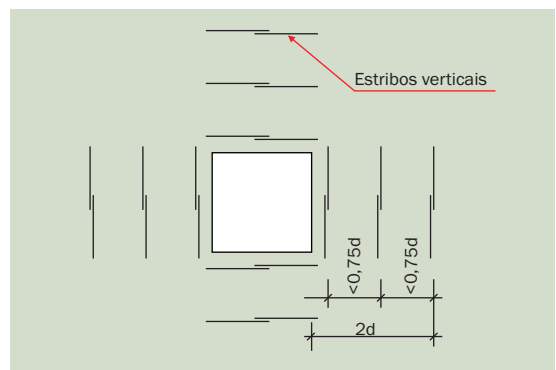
ESTRIBOS COMO ARMADURA DE PUNÇÃO - VISTA EM PLANTA
